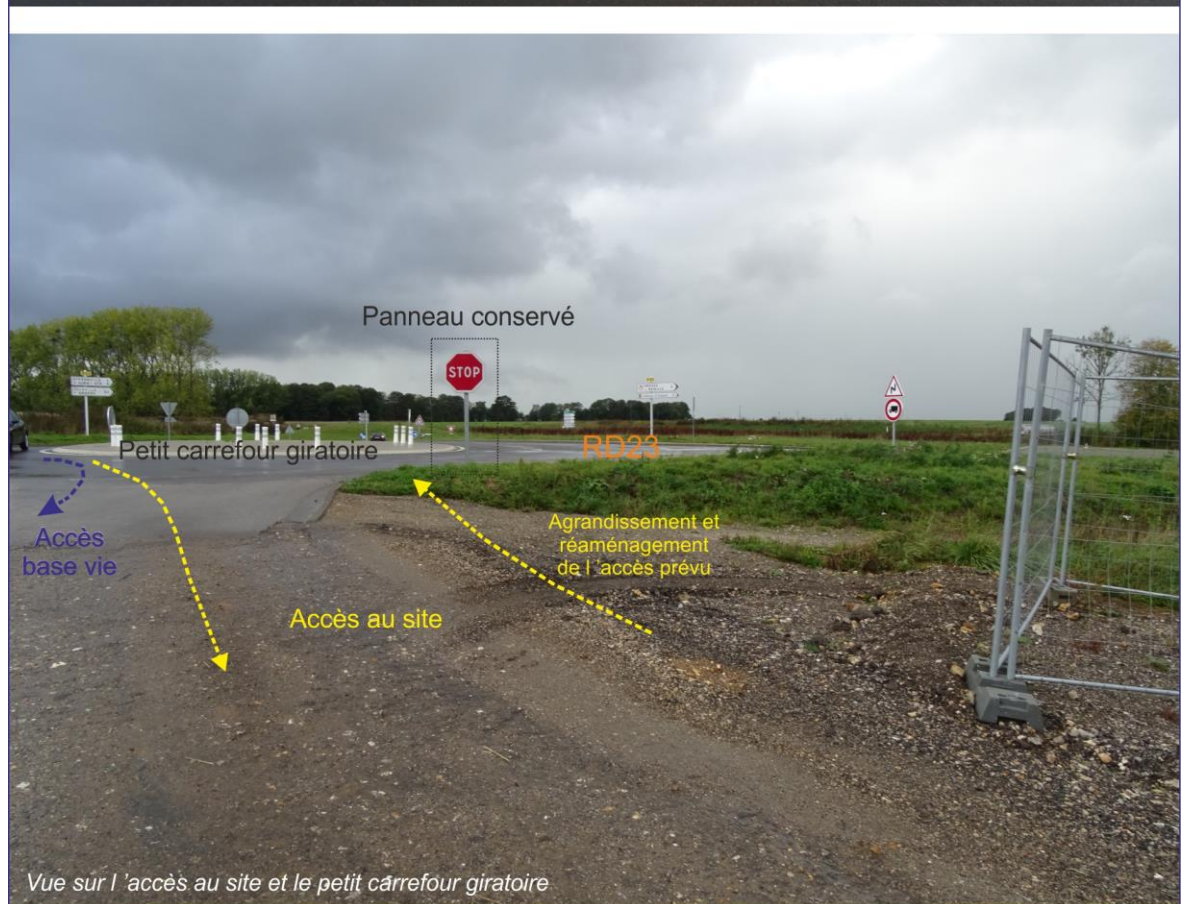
Vue sur le futur accès au site et le petit carrefour giratoire
